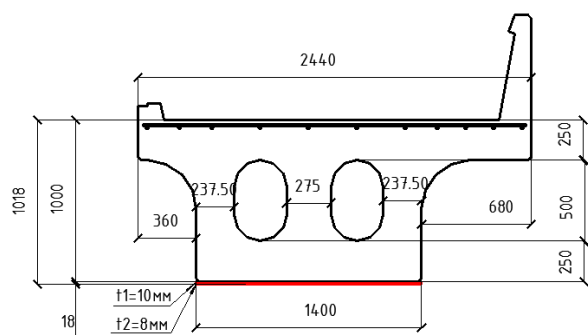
Зовнішнє армування плитної прогонової будови з овальними поздовжніми отворами. Варіант №4
